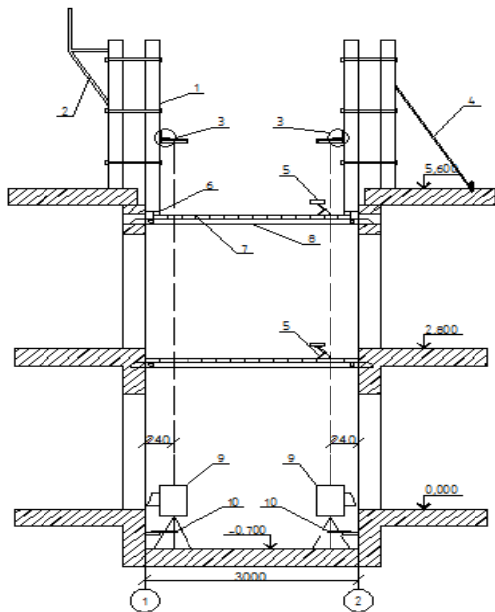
Схема контроля и устранения отклонений от вертикали при возведении лифтовой шахты прибором вертикального визирования: 1 – разборно-переставная опалубка, 2 - площадка бетонирования, 3 - узел крепления уголка к каркасу опалубки, 4 – подкос, 5 - металлические конструкции для монтажа деревянного настила, 6 - деревянная подкладка, 7 – настил, 8 - инвентарные подмости, 9 - прибор вертикального визирования PZL-100, 10 – кронштейн
